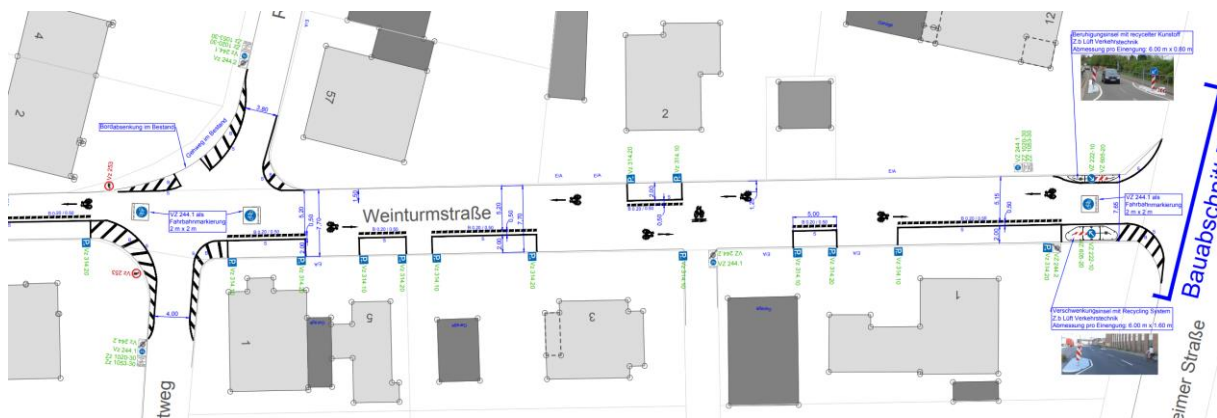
Ausschnitt Detailplanung Fahrradstraße Weinturmstraße (eigene Darstellung (VAR+, 2023))
